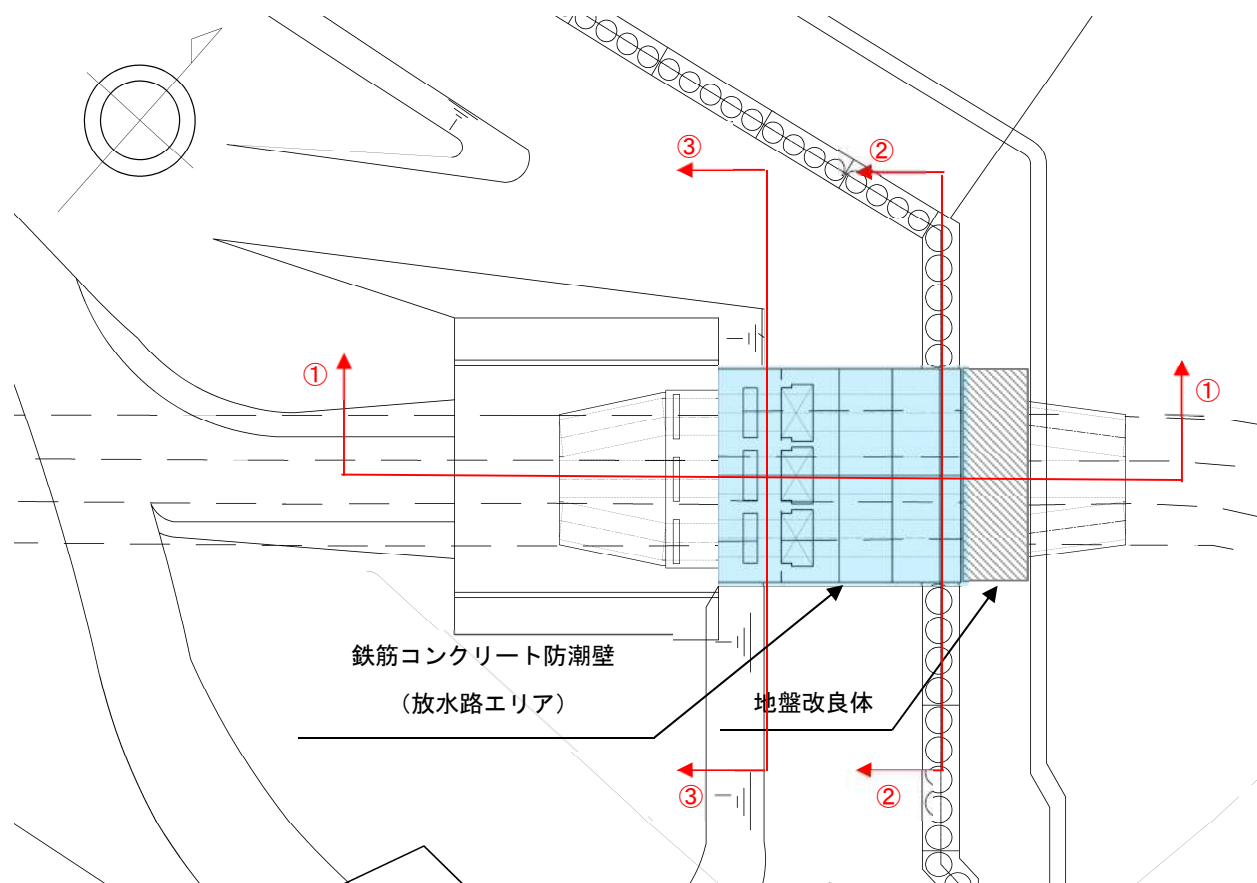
鉄筋コンクリート防潮壁（放水路エリア）の評価対象断面位置図
